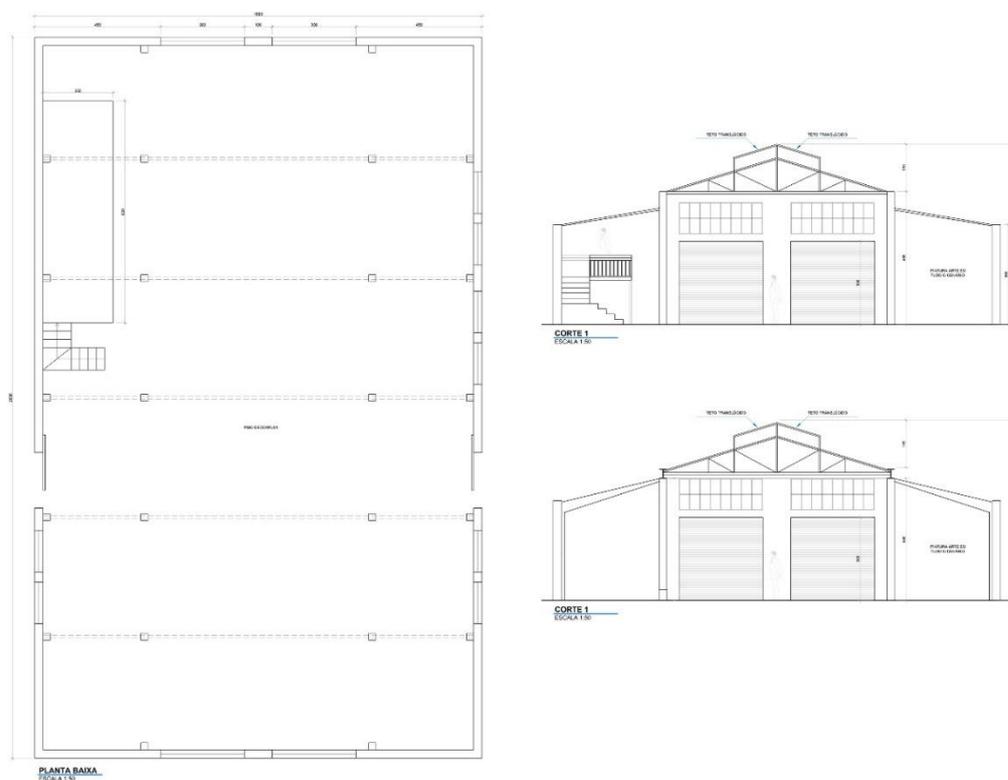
Primeira planta e primeiros cortes. Fonte: arquivo pessoal.
